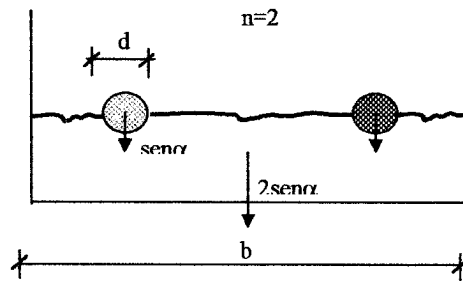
Falla en el plano del armado. (Nielsen [16])
